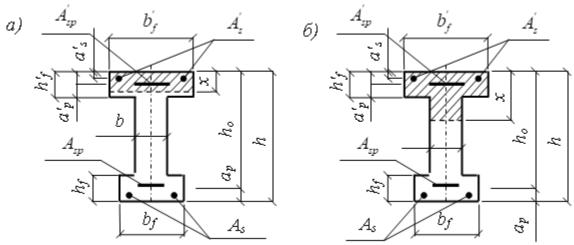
Форма сжатой зоны в двутавровом сечении железобетонного элемента: *а - при расположении границы сжатой зоны в полке; б - то же, в ребре
